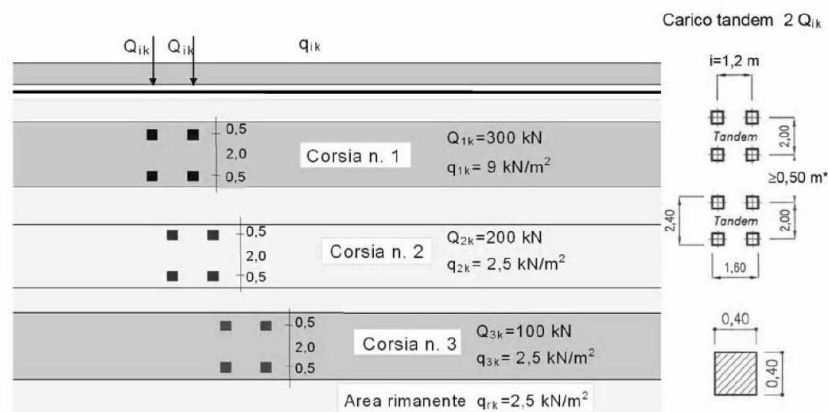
Schemi di Carico 1- Dimensioni in [m]
